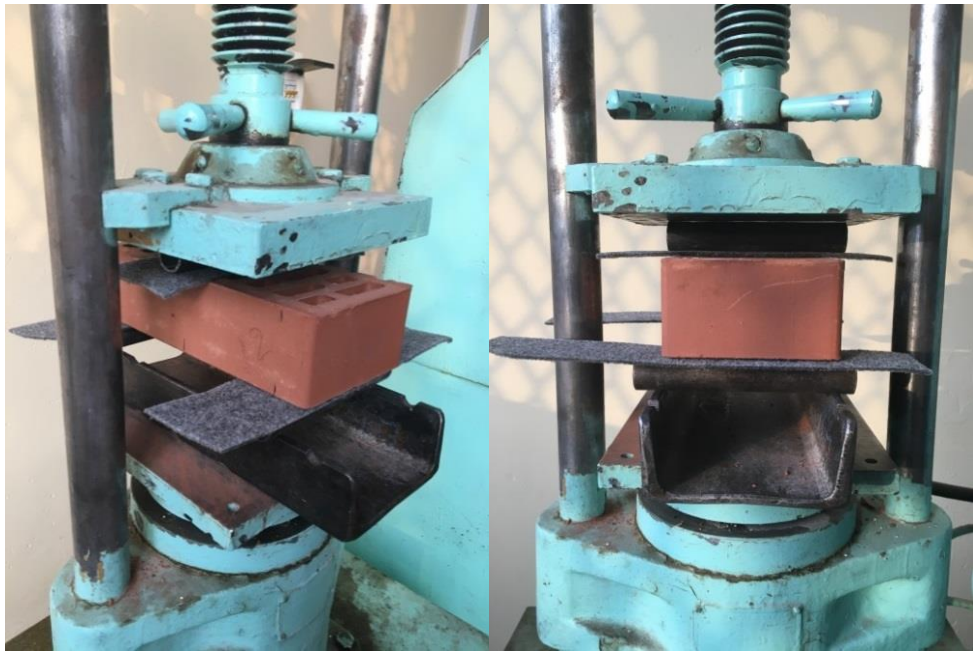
Установка образца №1.2 в пресс «П-10»
